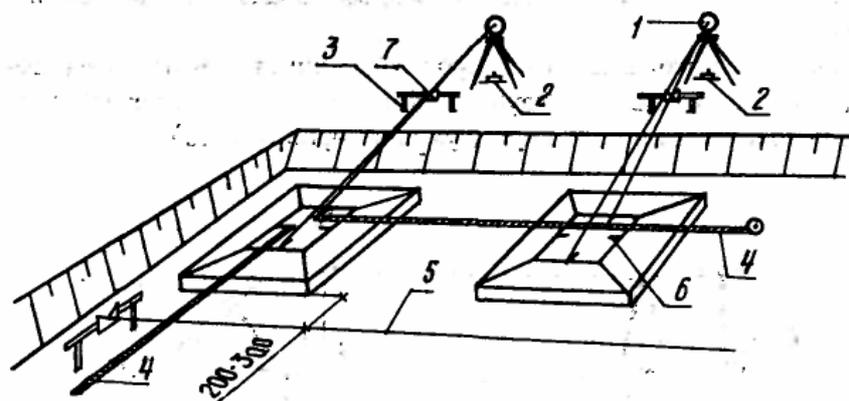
Схема перенесения осей фундамента в котлован с помощью теодолита:
